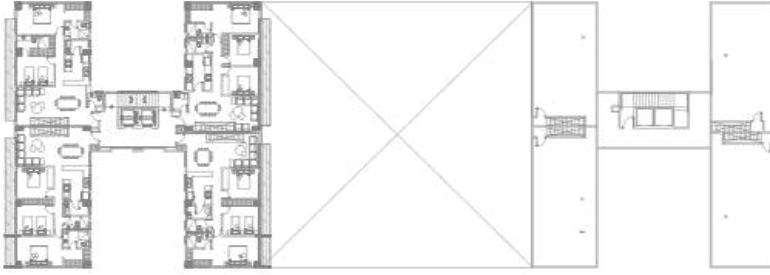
Planta de azoteas esquemática de conjunto, proyecto Wind Universidad.
